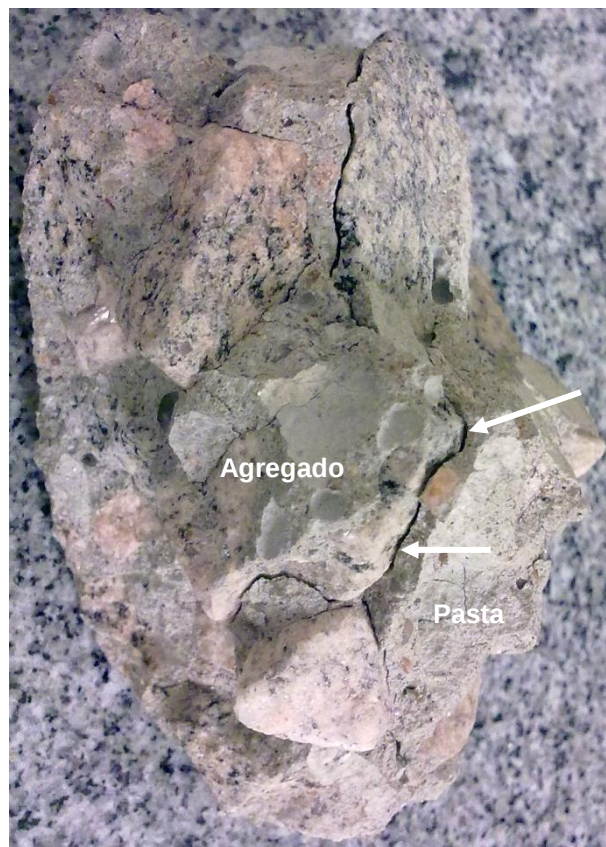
Fissura na interface pasta/agregado.
